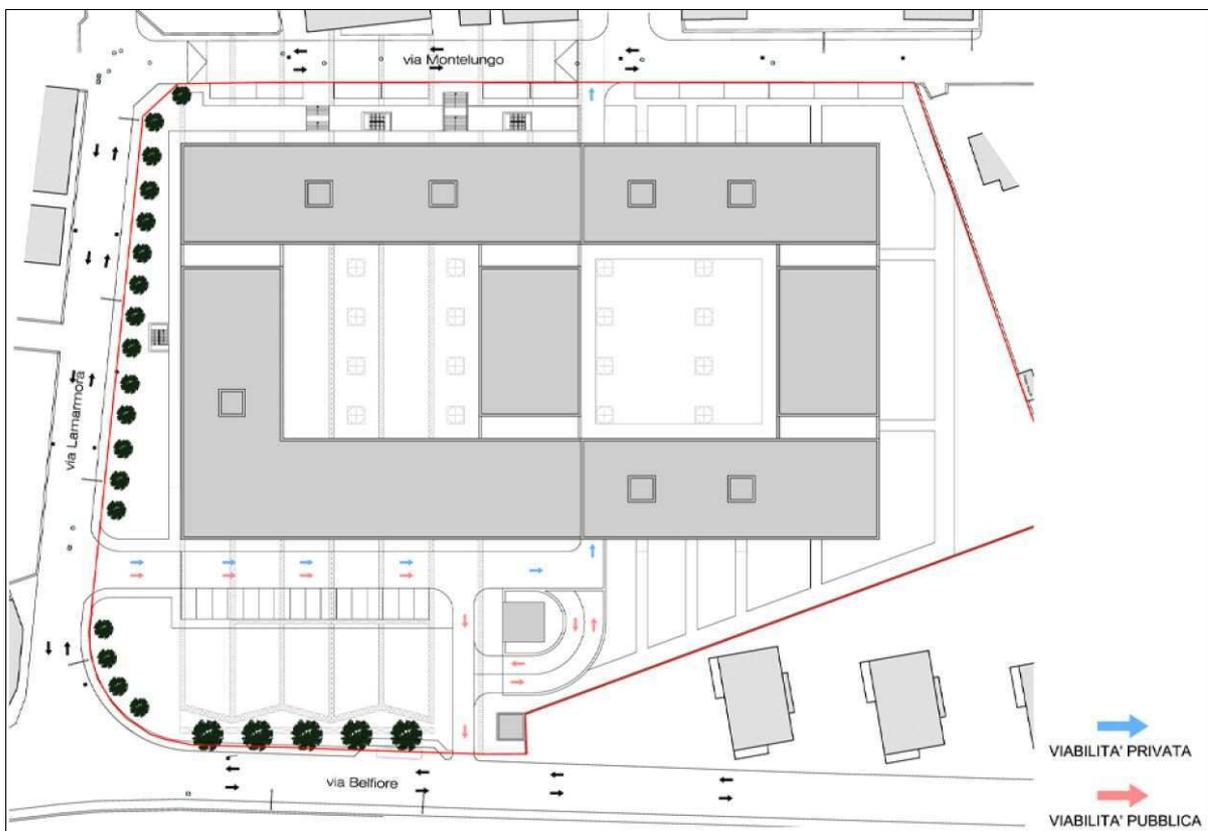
planimetria dell'area di intervento con ubicazione delle uscite dalle aree di sosta
